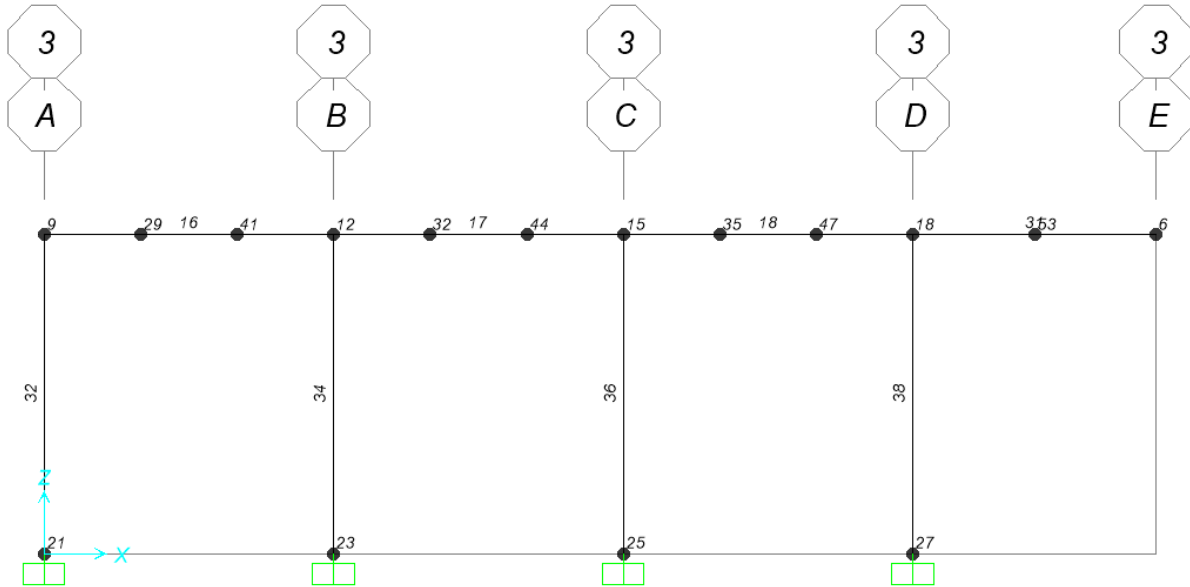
Vista in sezione modello struttura in elevazione –Filo 3 - numerazione elementi frame e joint
